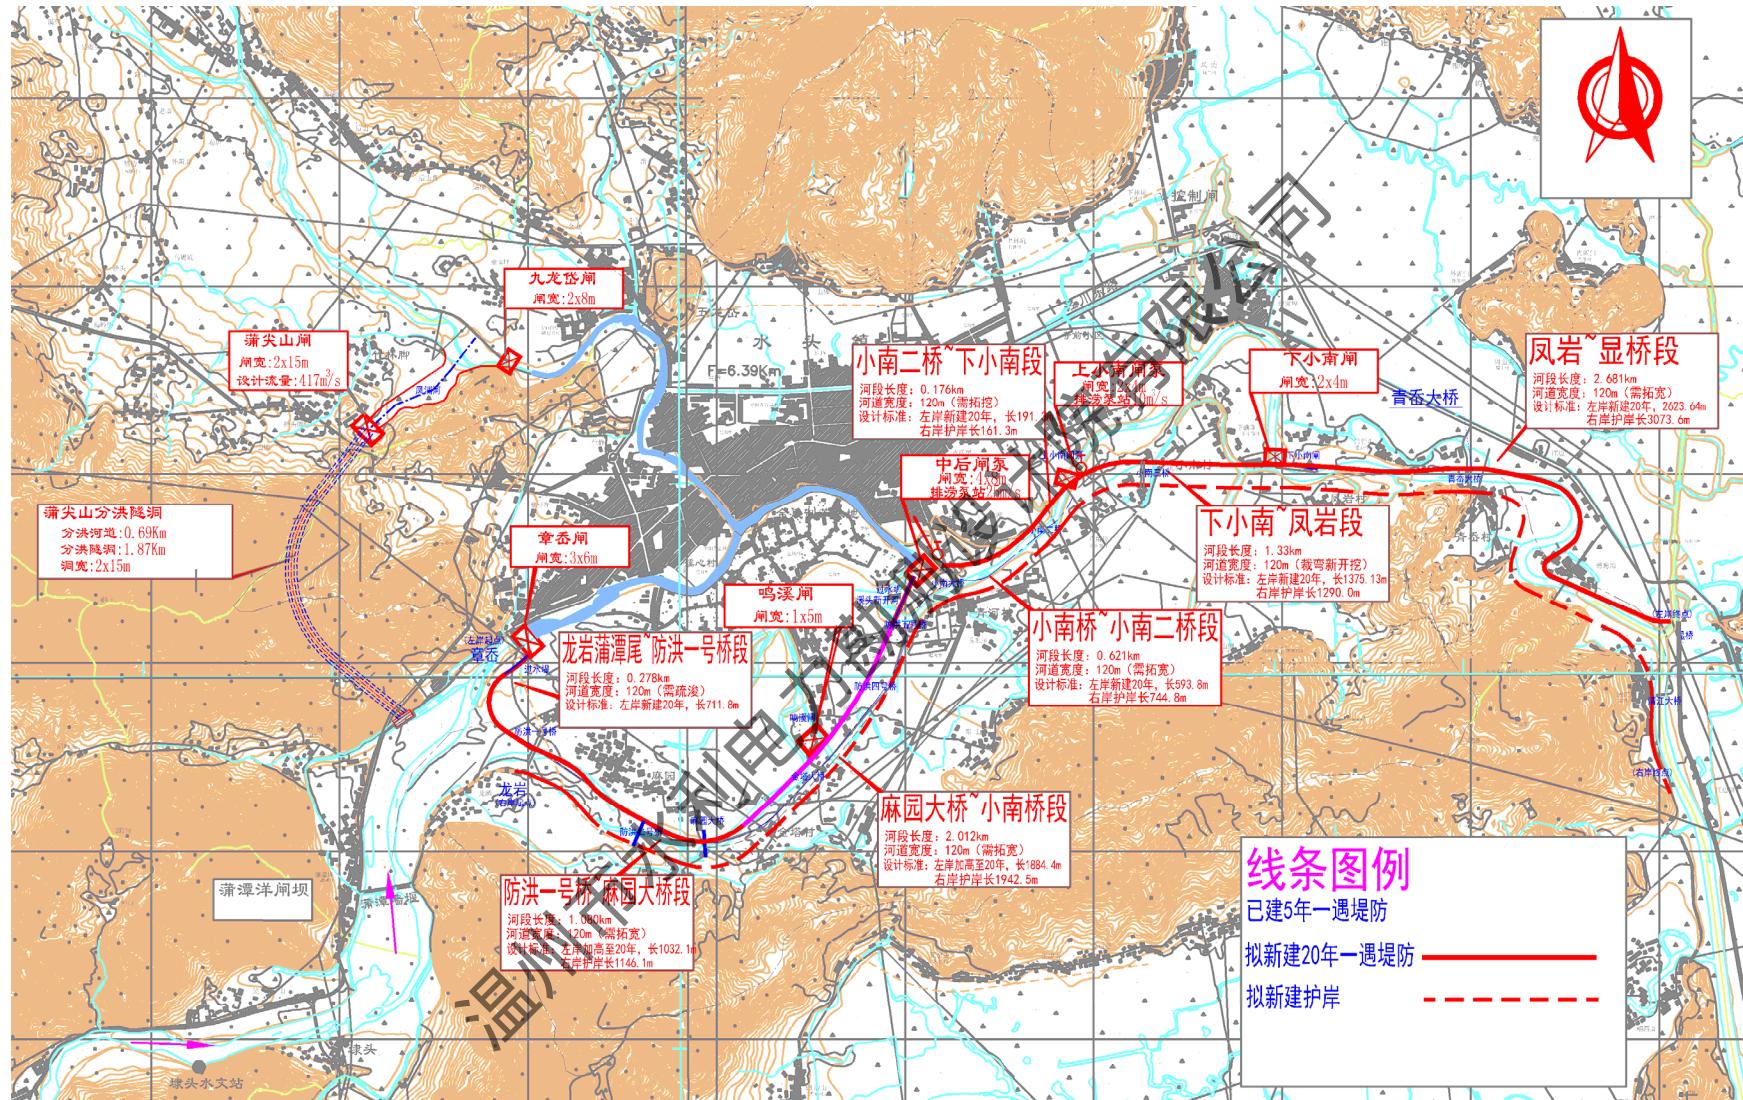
平阳县鳌江干流治理水头段防洪工程平面布置图
